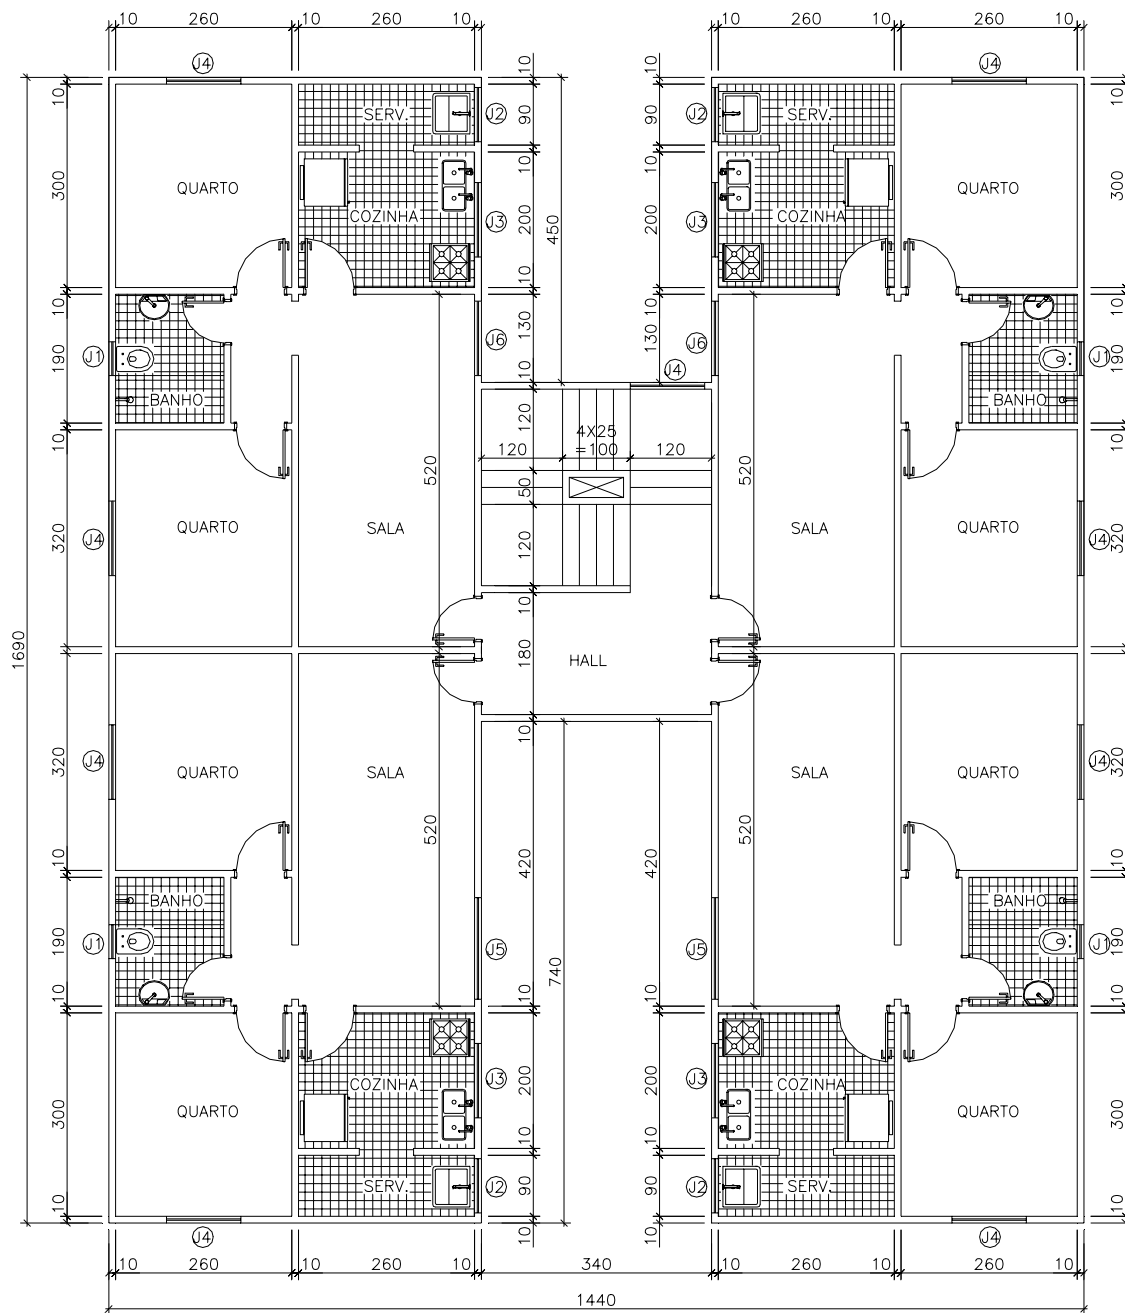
Residencial “SF” – Pavimento Tipo
